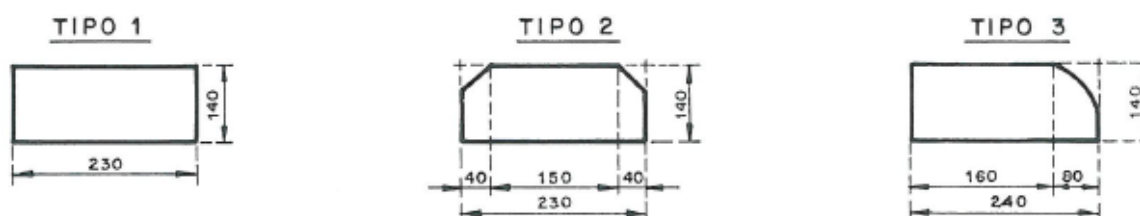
Dimensões das travessas de madeira de pinho (mm). Comprimento habitual - 2,60m. (Fonte: Adaptado da Norma Espanhola NRV3100, Março 1981)
